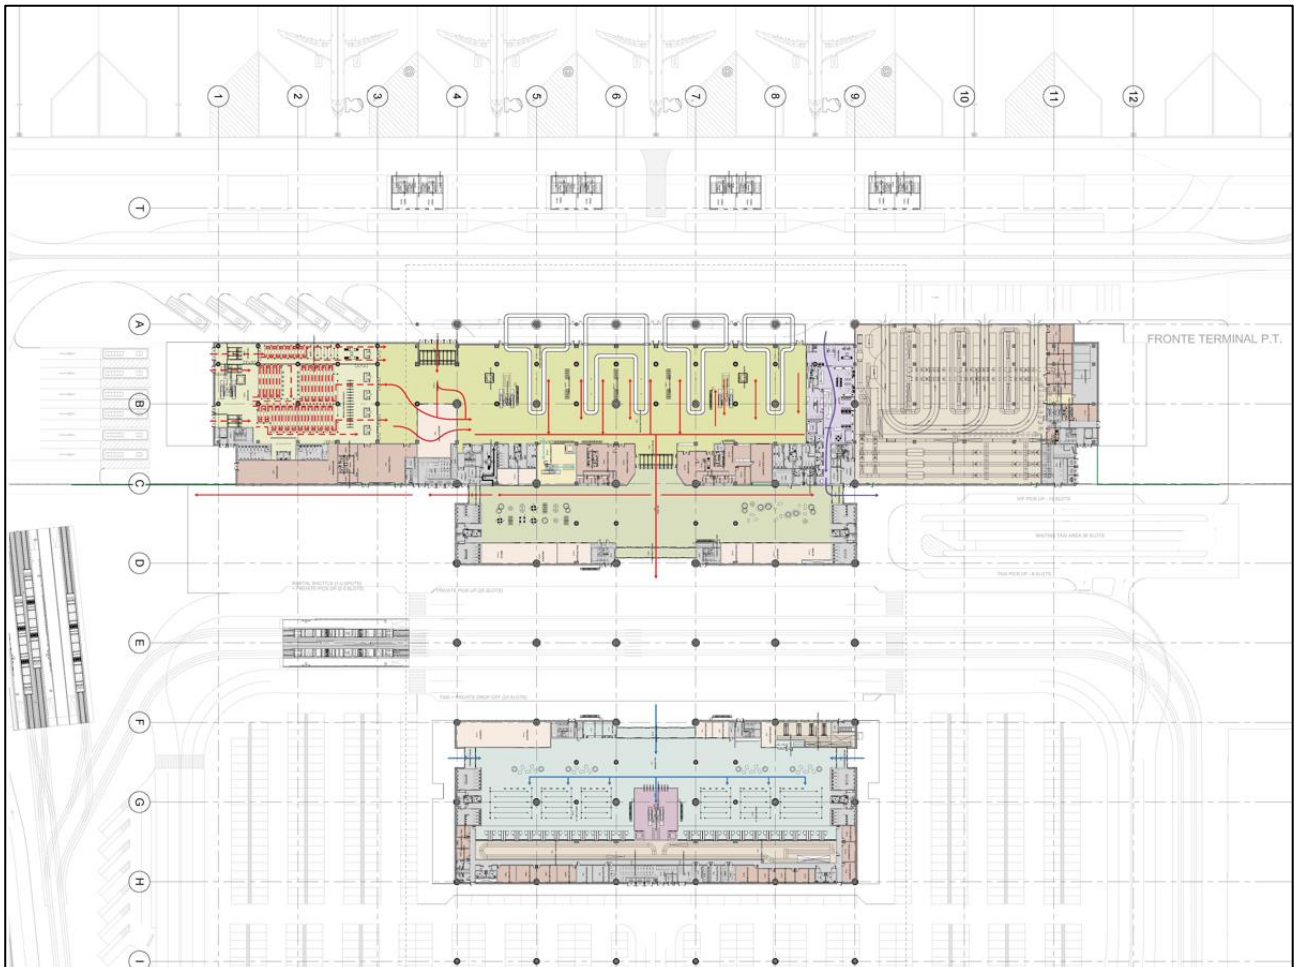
| Planimetria di flussi passeggeri del Piano Terra 2026.
